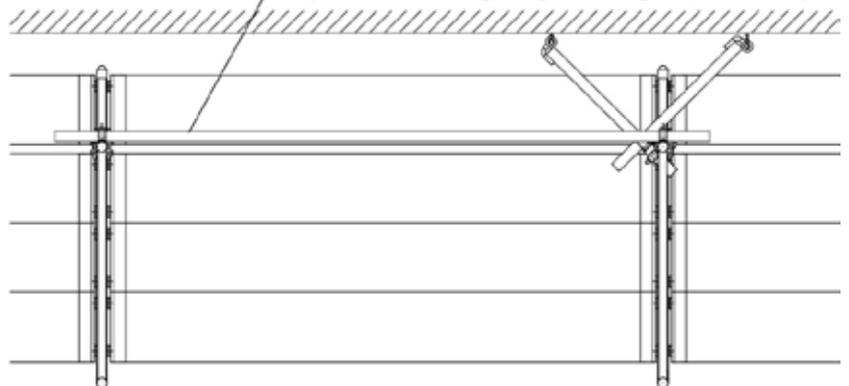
V-Anker mit Gerüstrohraussteifung
